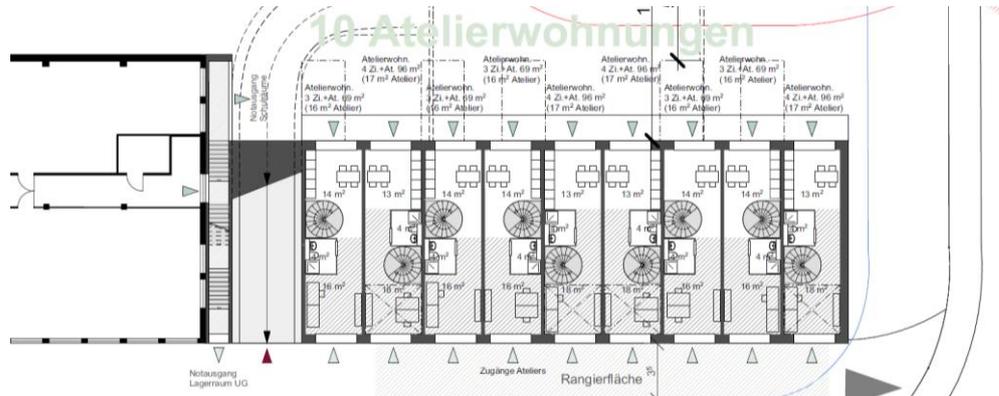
Grundriss Erdgeschoss Atelierwohnungen im Baubereich A1
